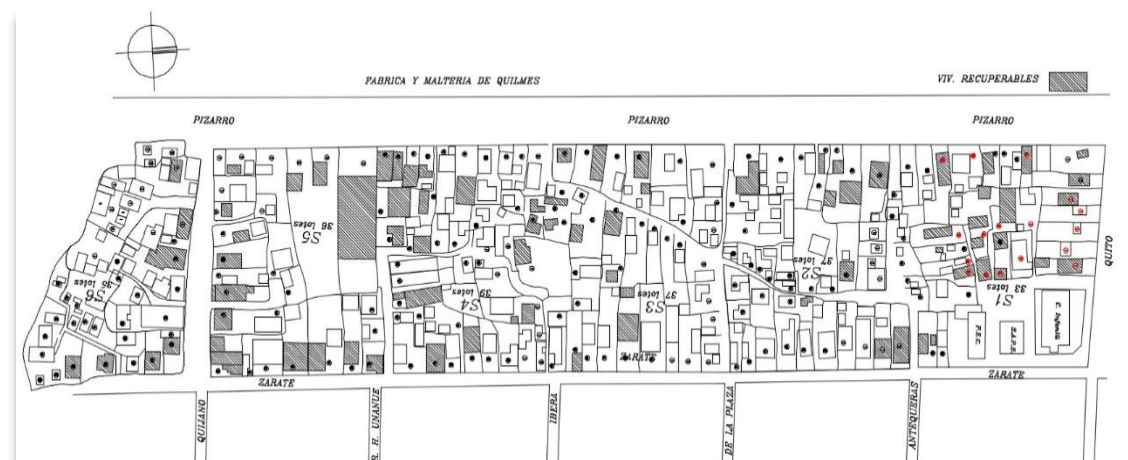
Plano de Estado inicial del sector de intervención. Fuente: INVICO.
